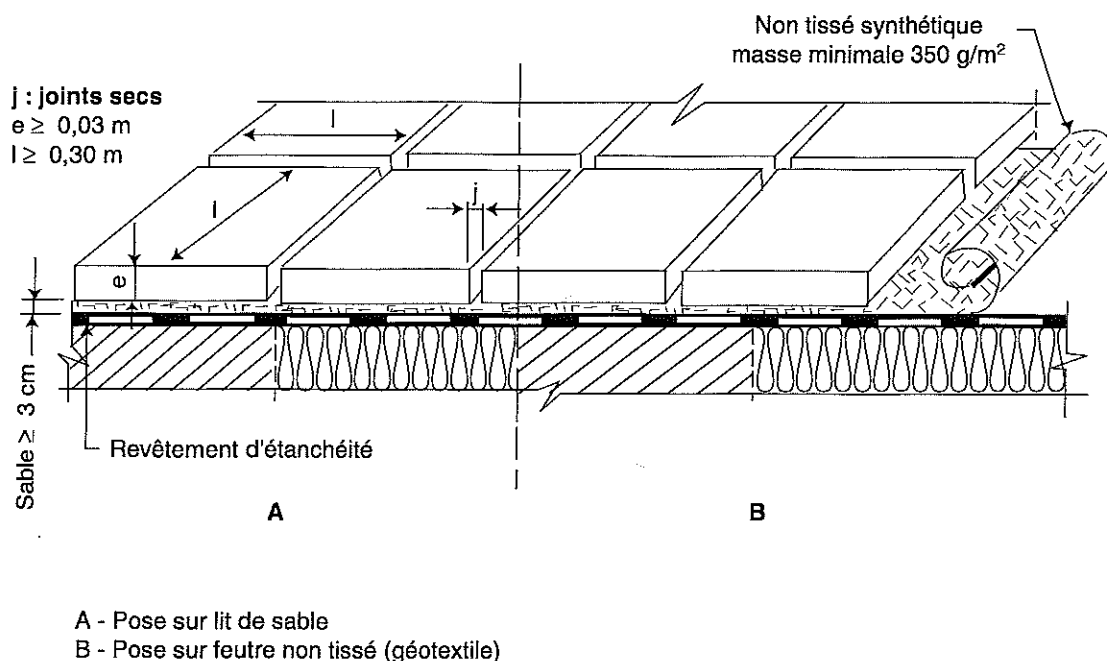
Protection par dalles béton (d'après DTU 43.1).
